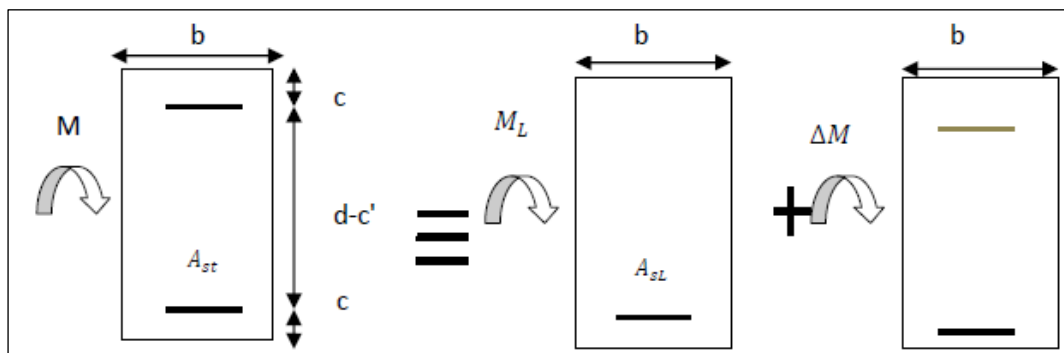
Schéma de Ferraillage des poutres doublement armée
